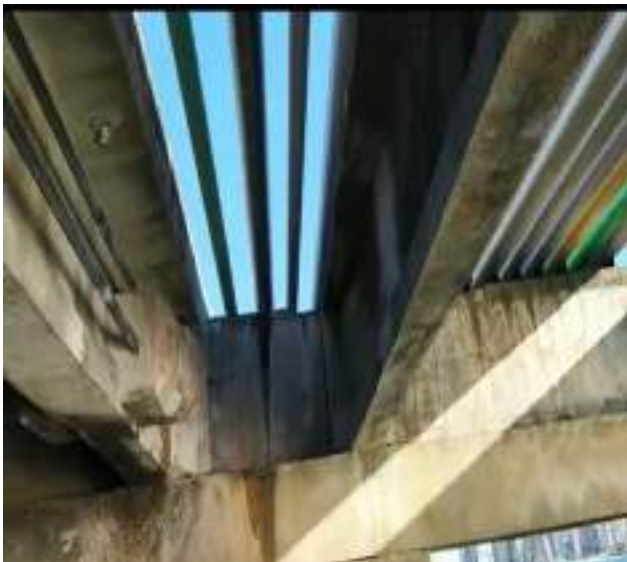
Vigas com fissuras – entre P41 e P42
